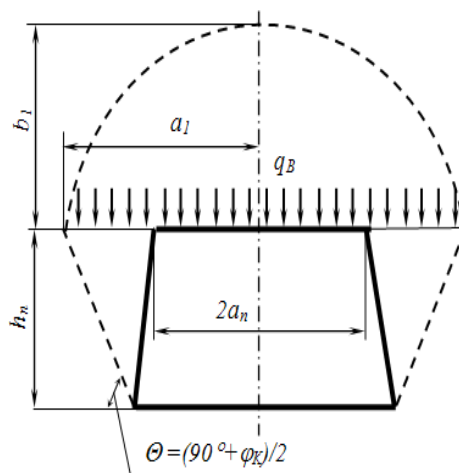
Схема формирования нагрузки на крепь по гипотезе П.М. Цимбаревича
